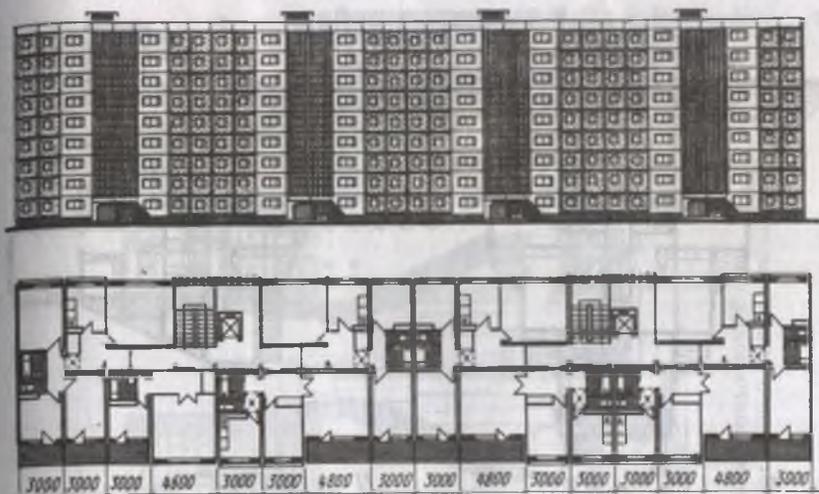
Фасад и план девятиэтажного объемно-блочного панельного дома (ЦНИИЭПЖилища)
